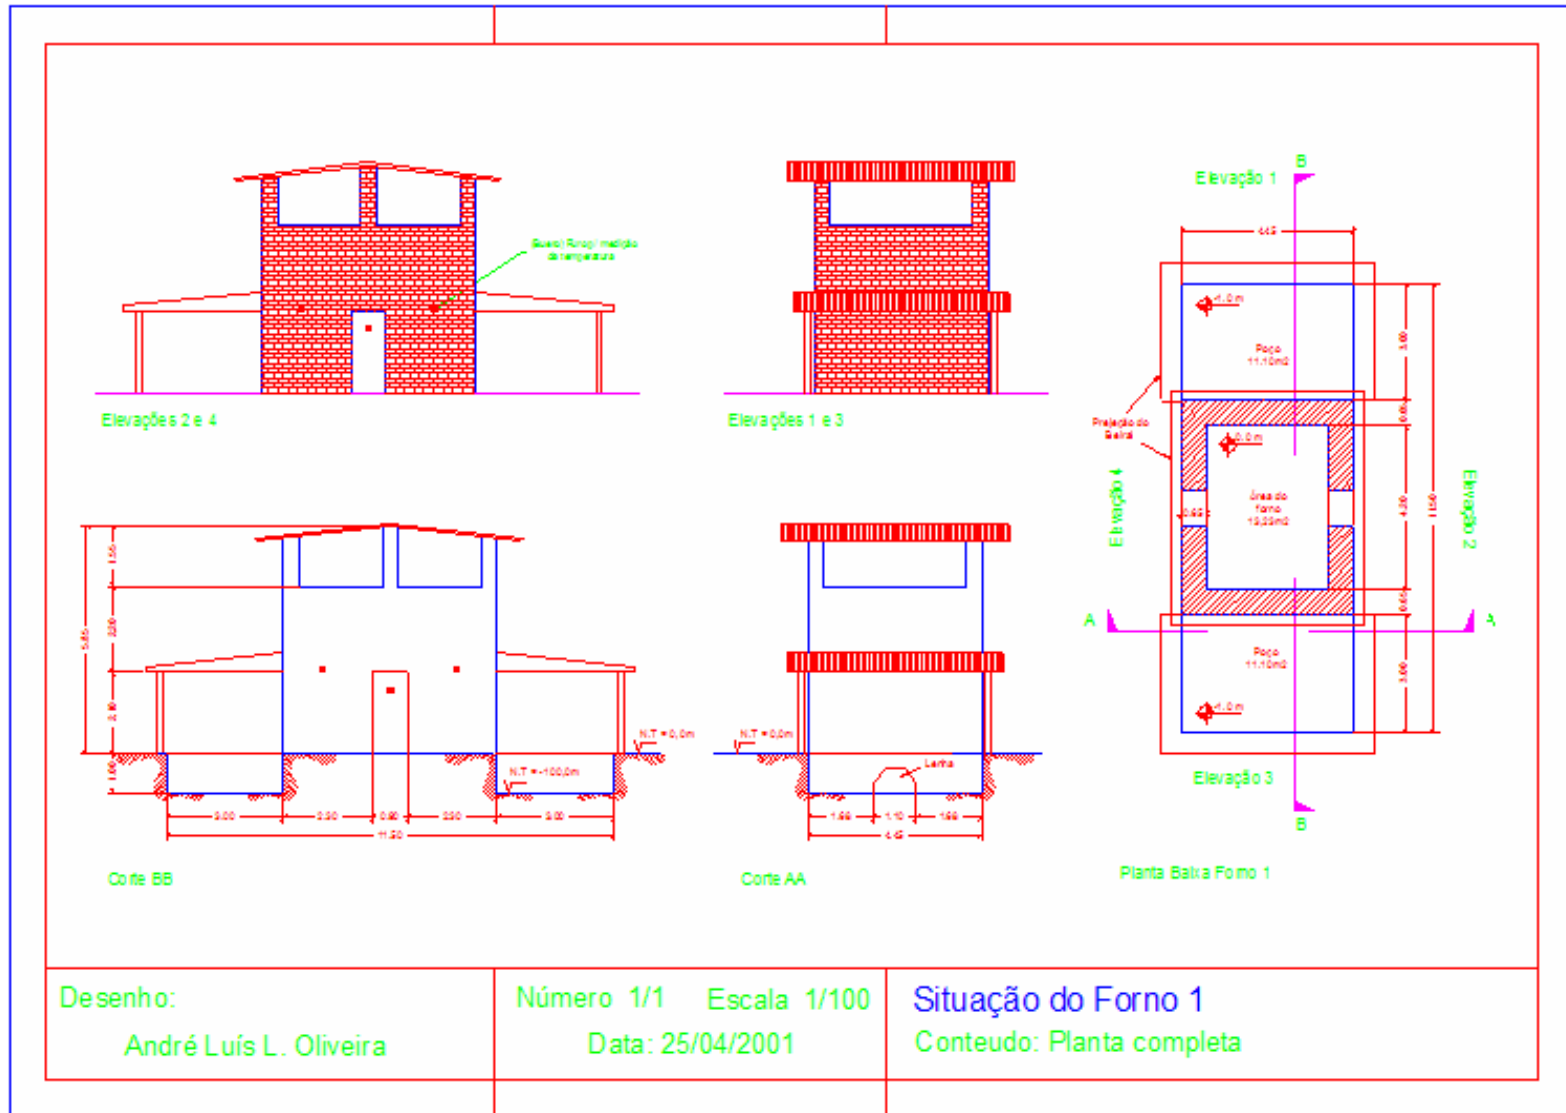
Planta geral e cortes do forno caieira (ALEXANDRE et al., 2002a).
